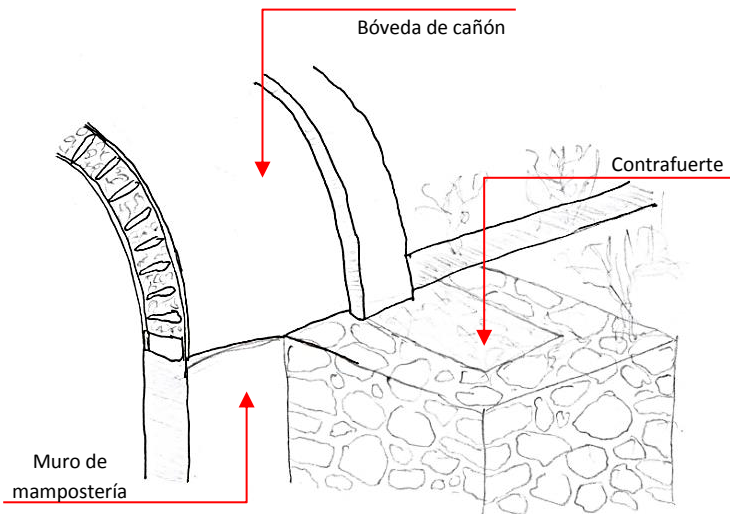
Croquis de detalle del sistema constructivo del contrafuerte, y demás elementos estructurales. 2017.
